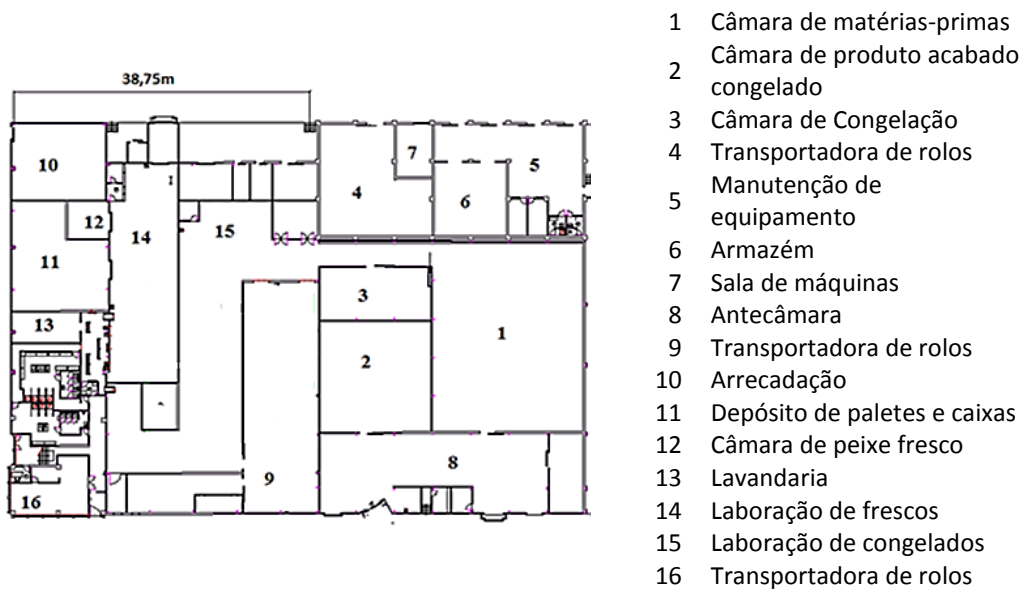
Planta do piso inferior da empresa de peixe do caso de estudo
